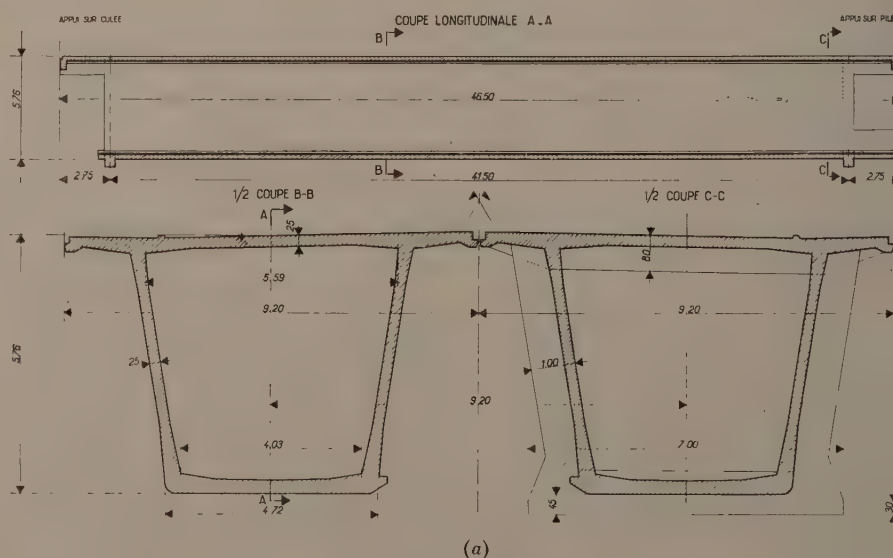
a et b. — Poutres en lagune. Coupe longitudinale et coupe transverse.
